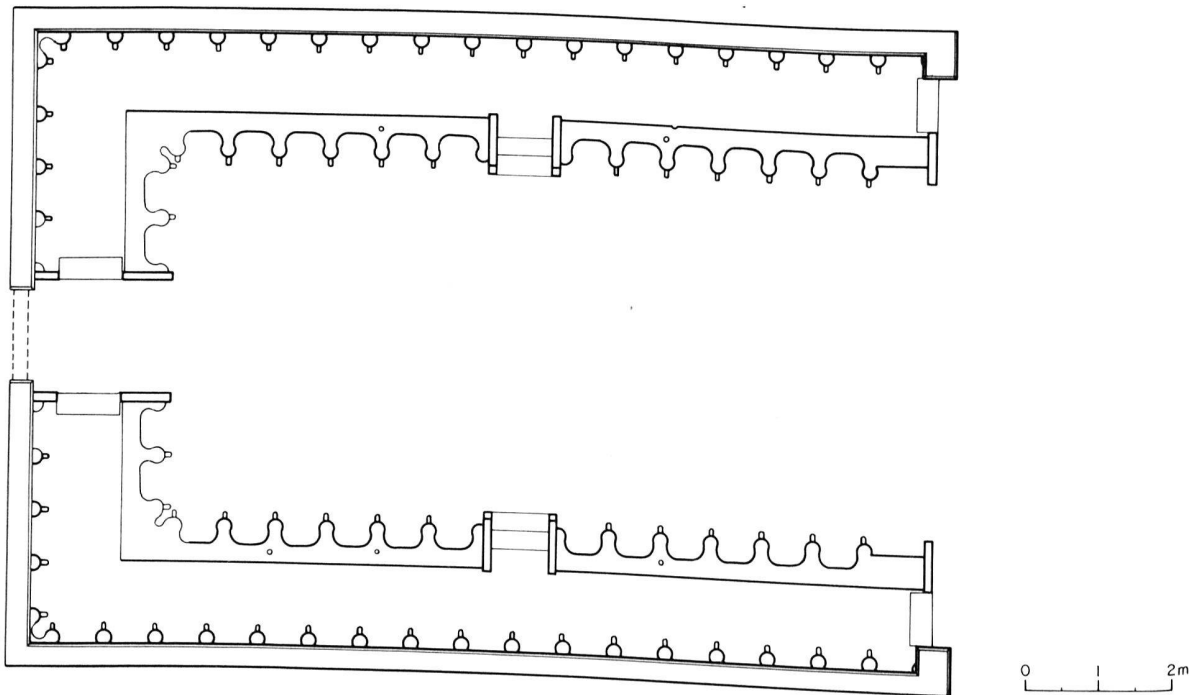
Fribourg/Couvent des Cordeliers. Plan reconstitué des stalles du début du XIV^e s. (1:100)
